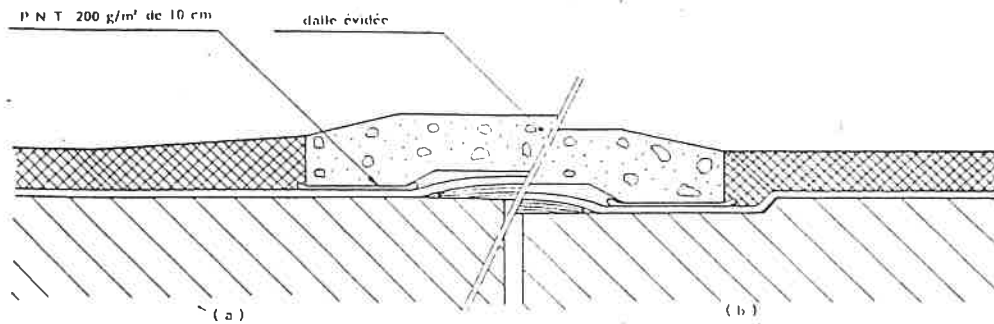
Protection des joints plats en toitures terrasses accessibles aux véhicules
